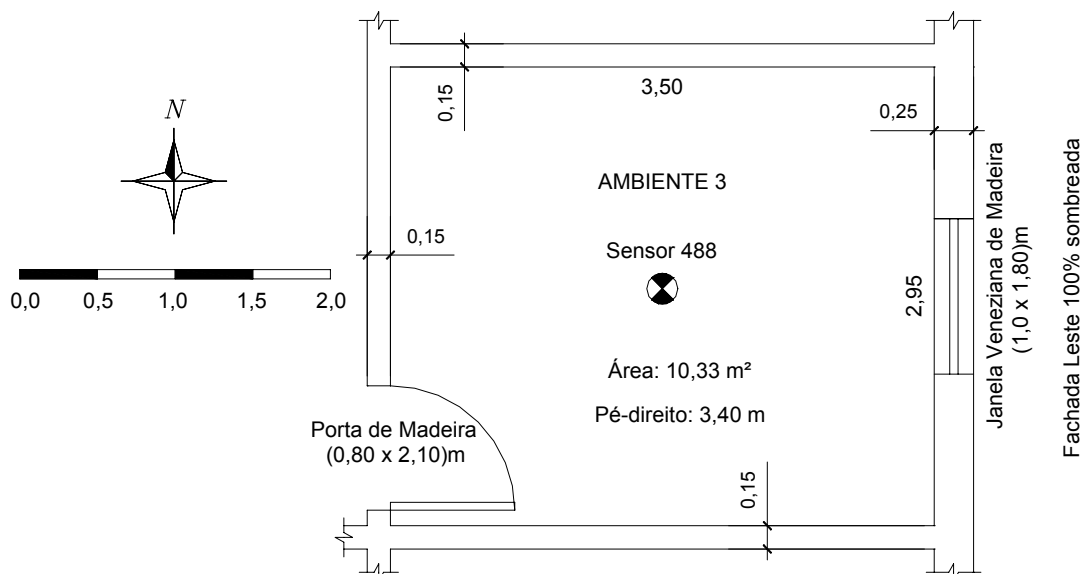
Planta baixa do ambiente monitorado - Edificação 3.
